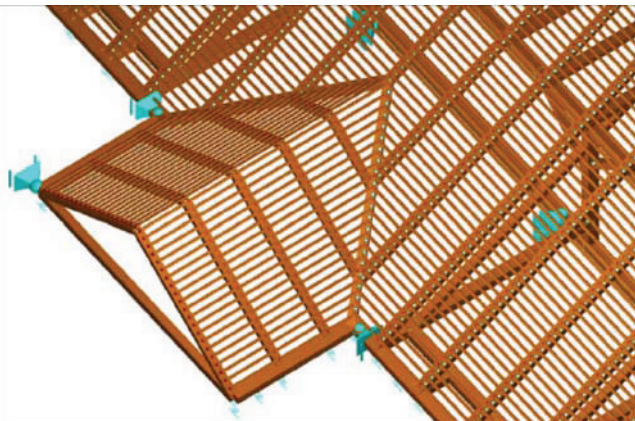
F.14 Darstellung des räumlichen Stabwerkmodells des Dachwerks inklusive Dachlattung in RSTAB.
